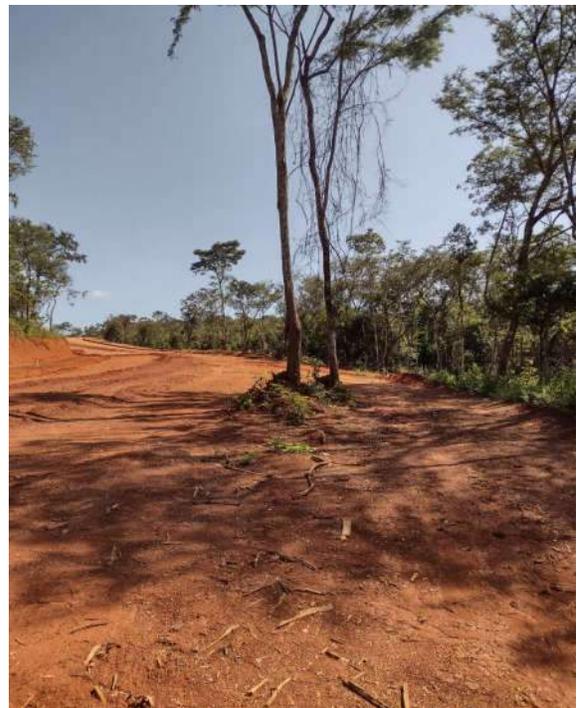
Jacarandá caviúna na área do sistema viário.
